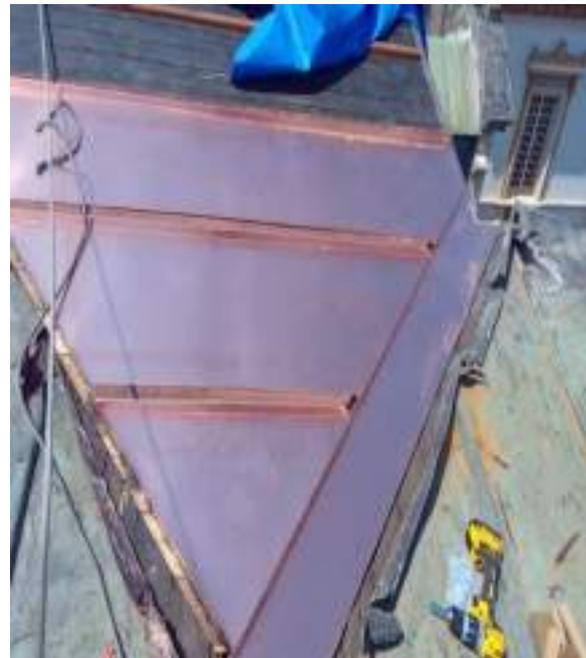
Atividade de conservação da cobertura, instalação das telhas em cobre.
